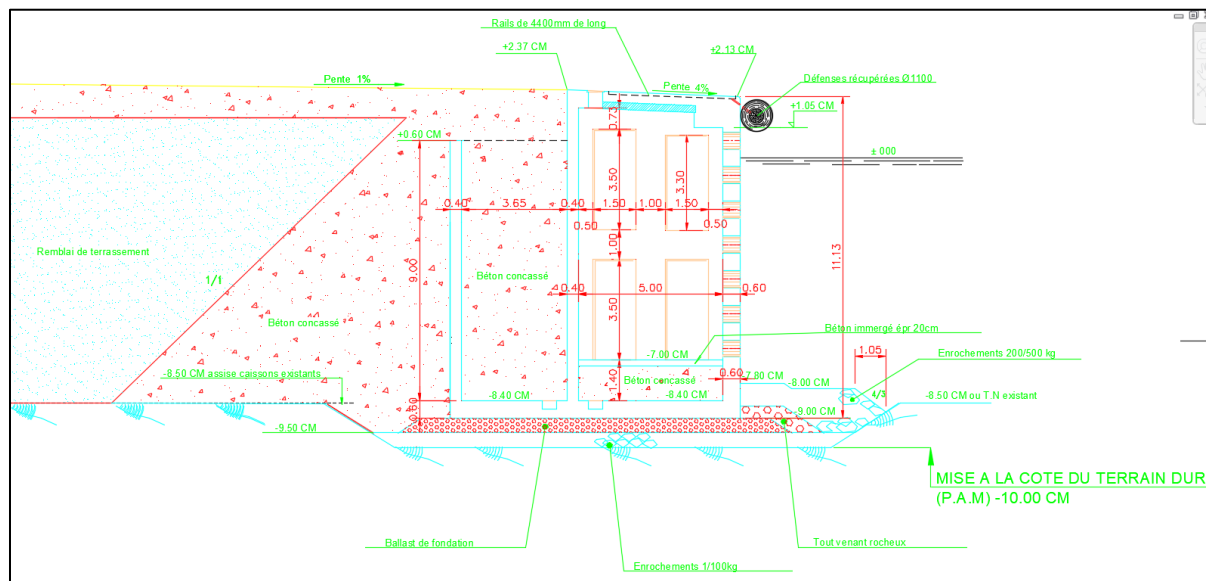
Vue en coupe d'un caisson et du remblai en arrière
